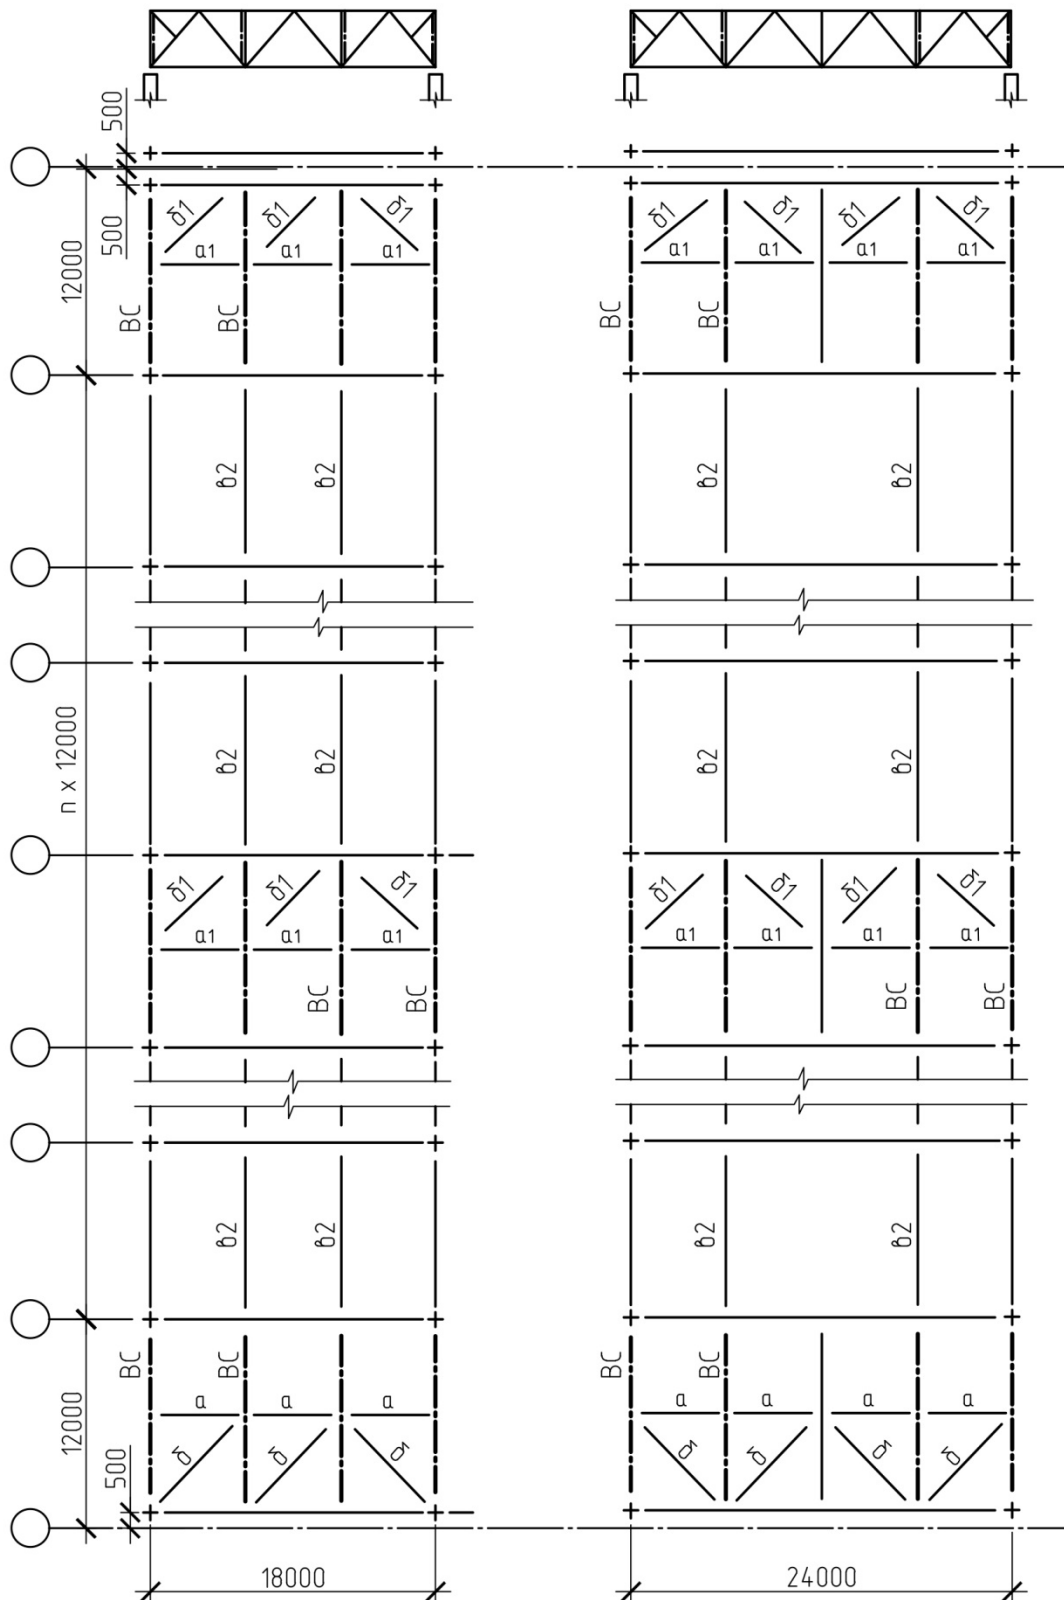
Схемы расположения связей II типа по нижним поясам стропильных ферм, шаг ферм 12 м, пролеты 18 и 24 метра
